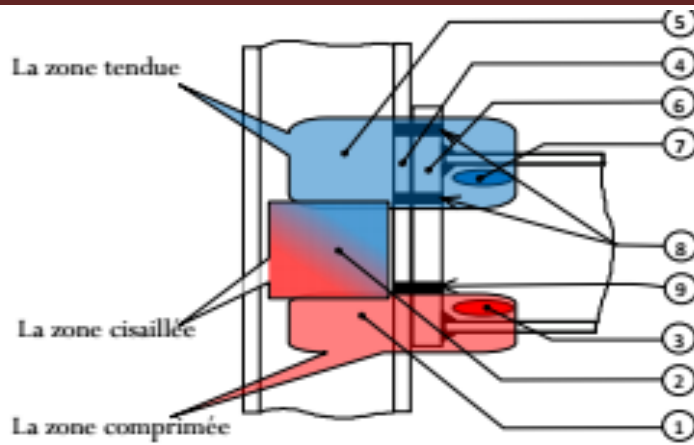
Composantes d'un assemblage poutre-poteau boulonné par platine d'extrémité.
